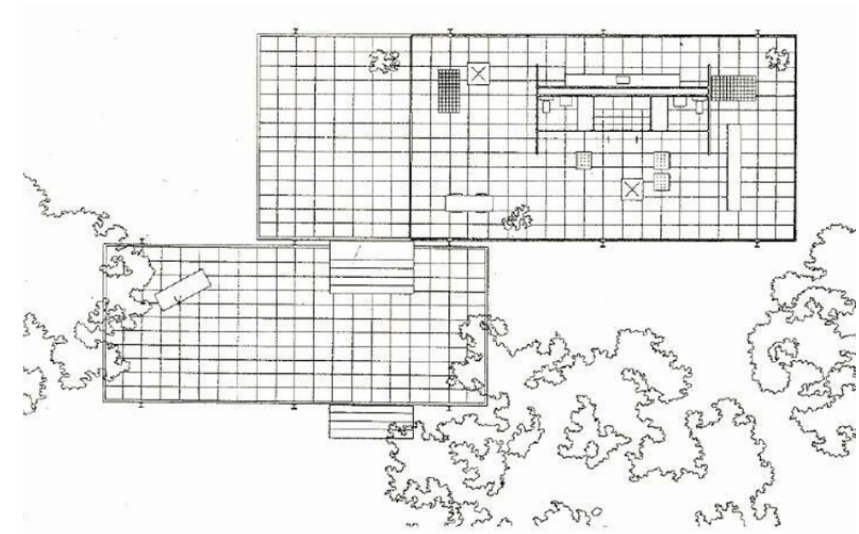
Mies van der Rohe, Farnsworth House, Illinois, 1945-1951, Grundriss
